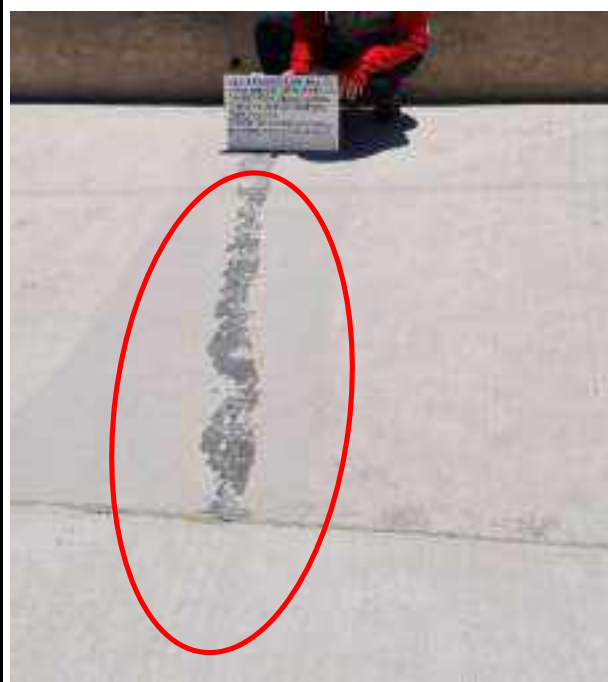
en la imagen se muestra una grieta transversal (GT), en la losa del pavimento rígido, en el Jr. Umachiri, de la localidad de ayaviri, de la provincia de melgar.
